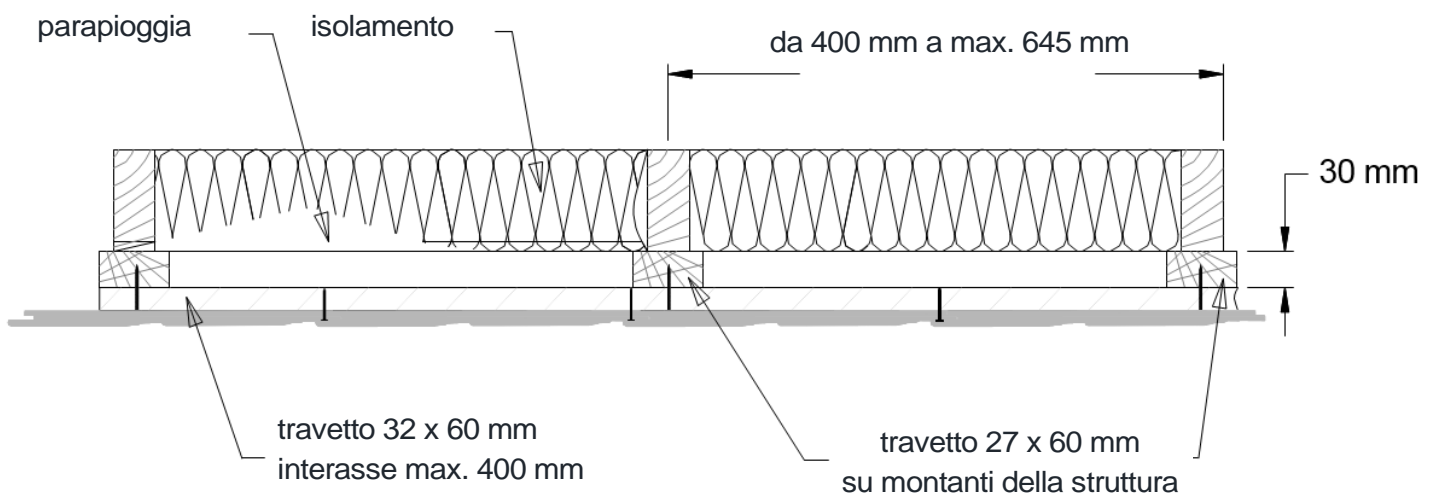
Sezione orizzontale su costruzione con struttura in legno – Posa verticale – Posa su doppia travatura
